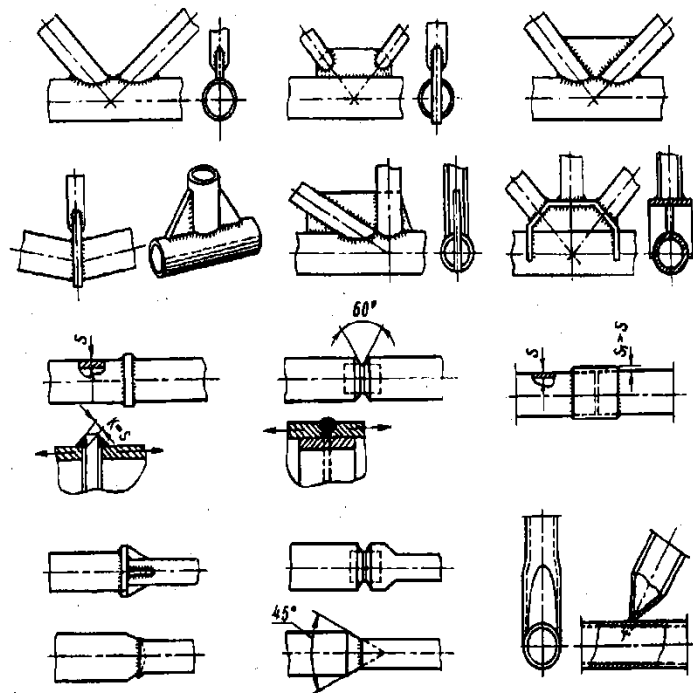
Стыки узлов ферм с трубчатыми стержнями и сварных стыков труб
